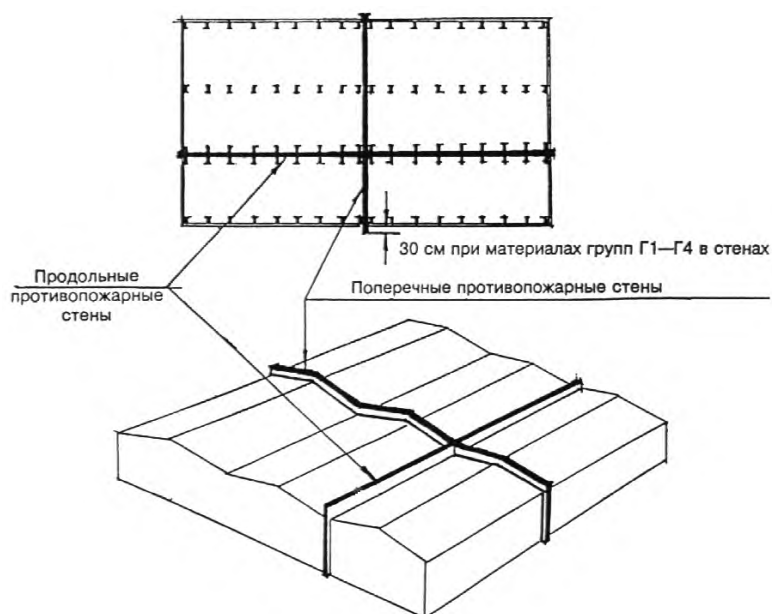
Разделение зданий на пожарные отсеки противопожарными стенами
